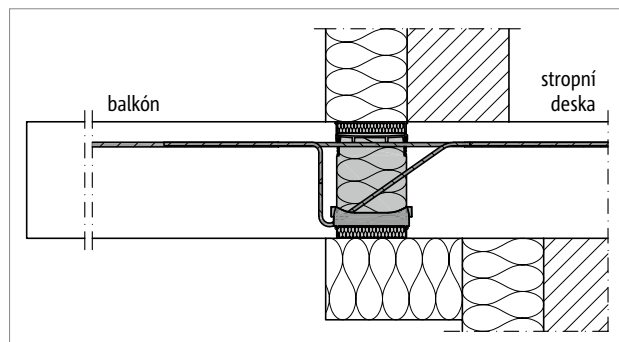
Schöck Isokorb® XT typ KL, QL-VV: Balkón ve vnitřním rohu, podepřený ze dvou stran
